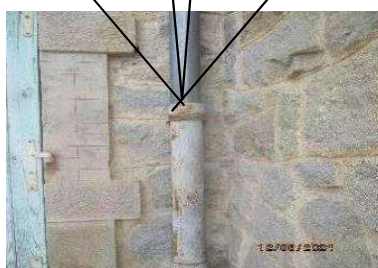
descentes d'EP en fonte et zinc sans amiante sur façades
